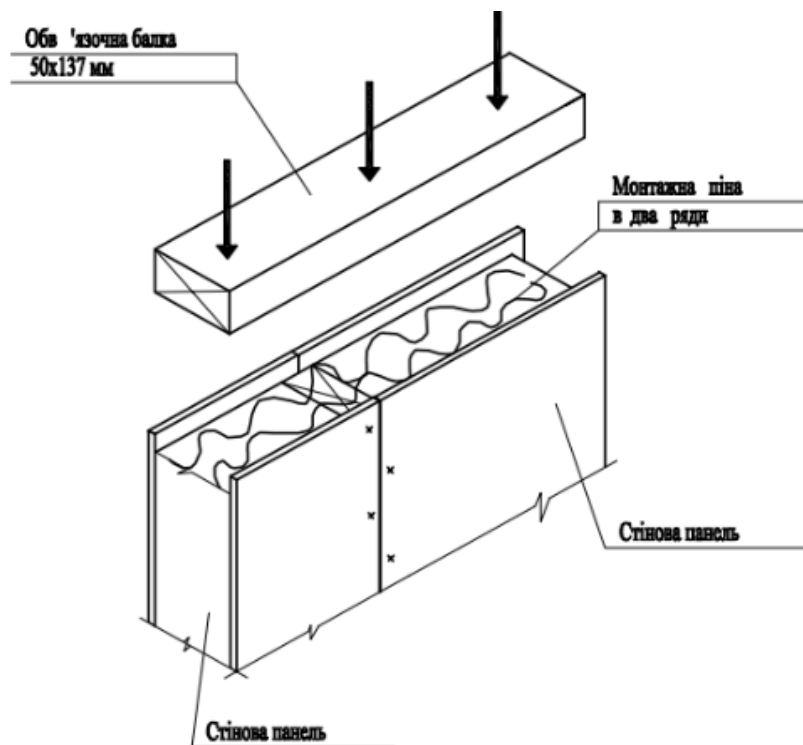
Монтаж обв'язки стін першого поверху.
